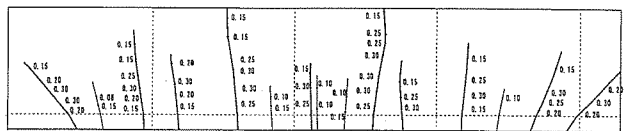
ひび割れ発生図（第4ブロック中壁）
